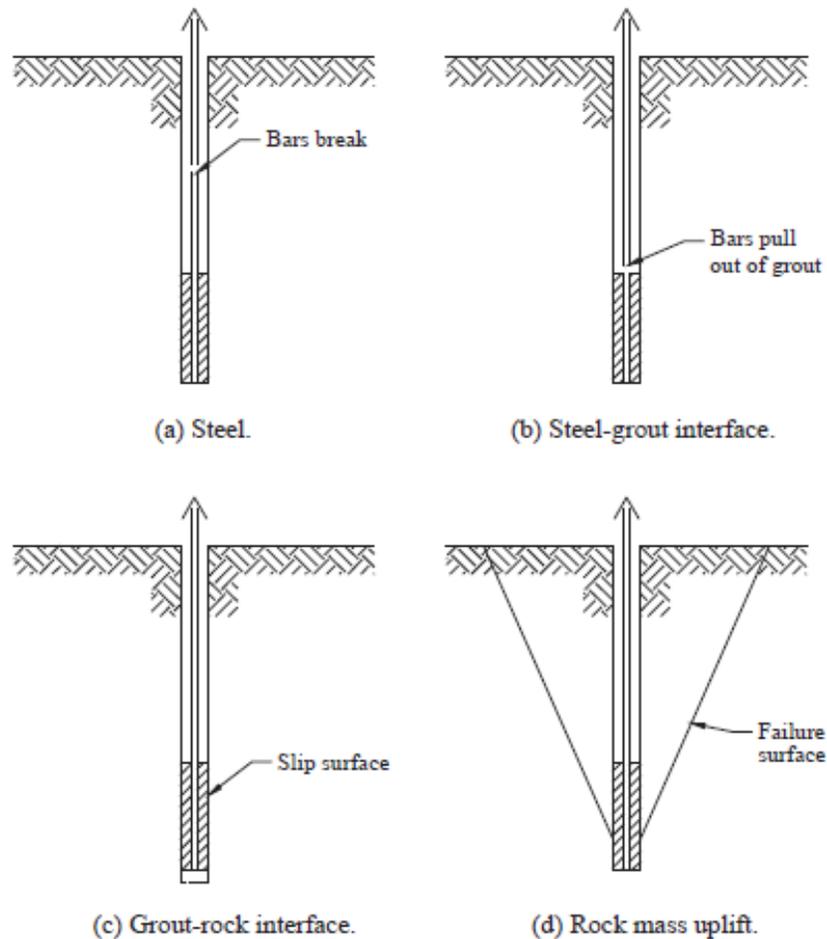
Modos de falla; adaptado de “Rock engineering design of post-tensioned anchors fo dams - A review”, por Brown, E.T., 2014
